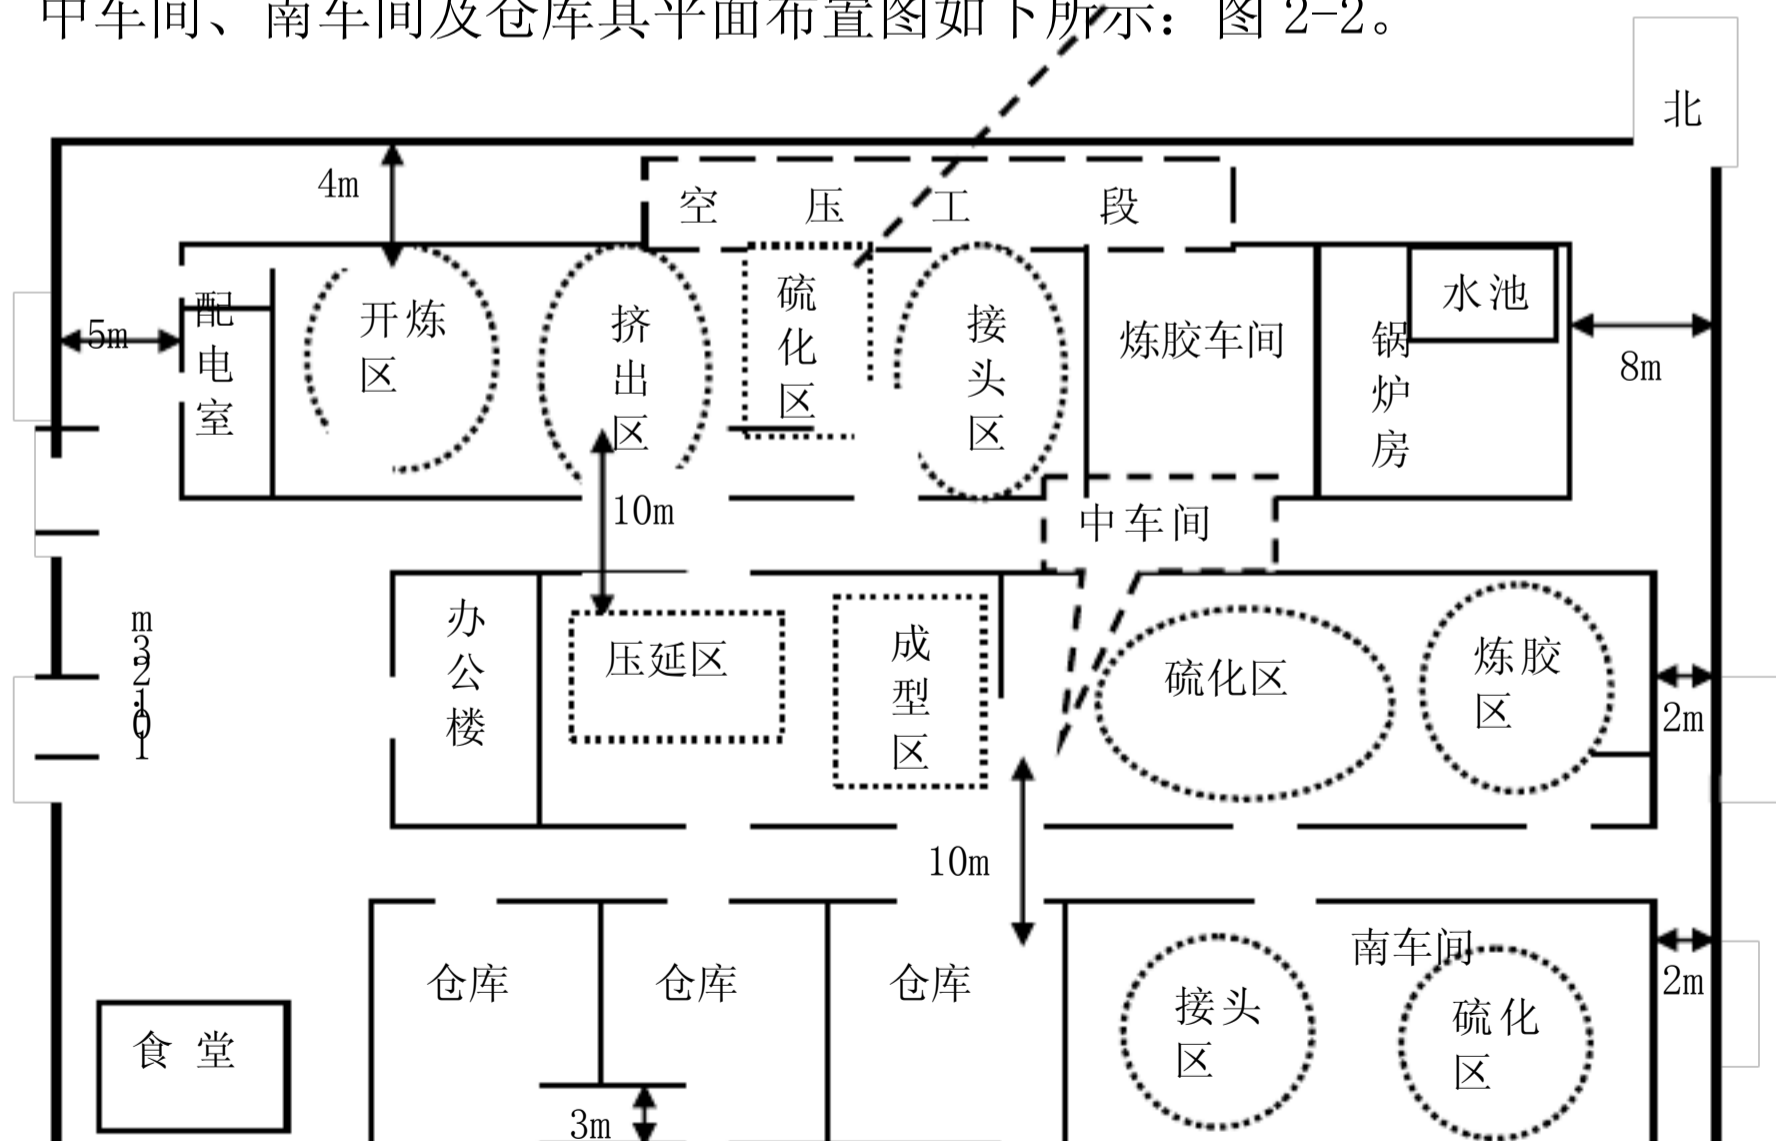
青岛正顺橡胶制品有限公司平面布置图
